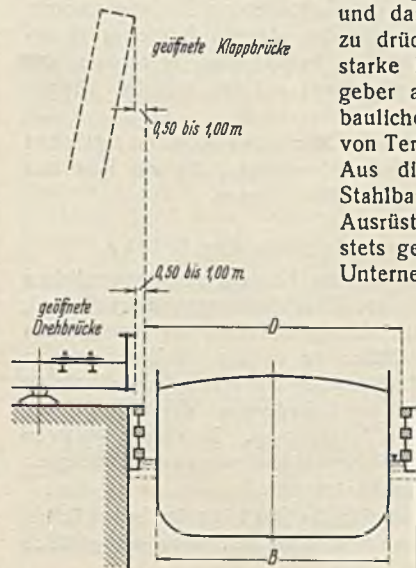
Lichtraum für Schiffsahrt (Klappbrücke und Drehbrücke).
